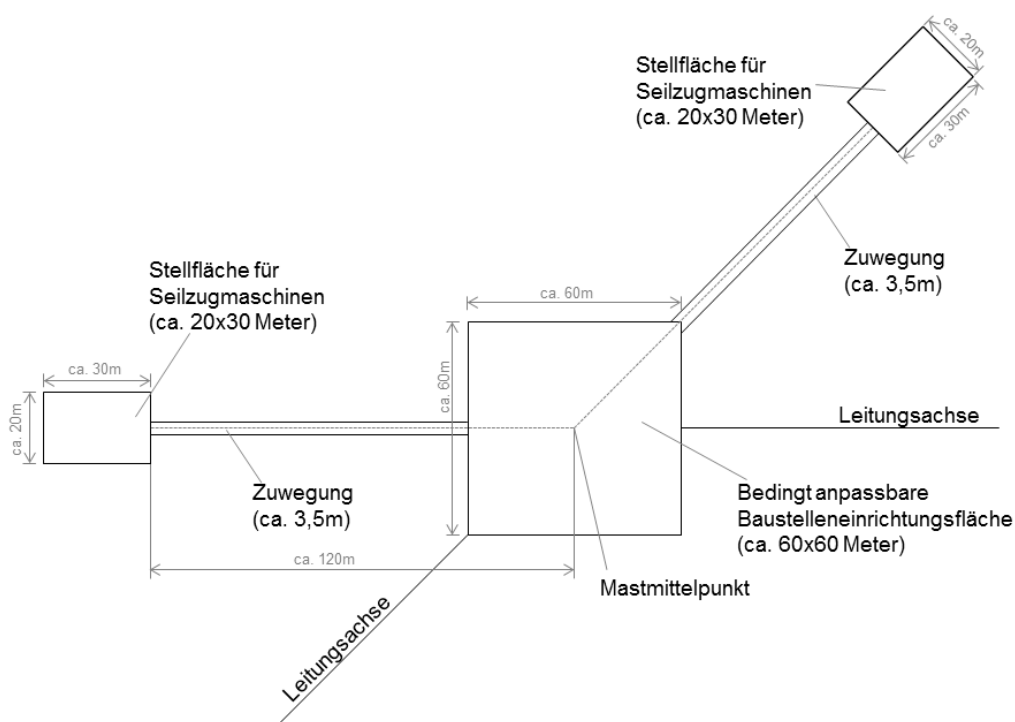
Schema der zusätzlichen Baustelleneinrichtungsfläche
